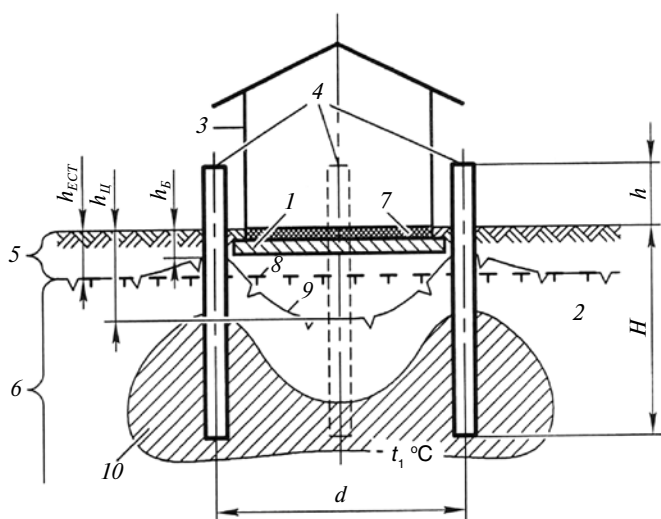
Схема на вечной мерзлоте здания с автономной системой охлаждения грунтов (дизайн первого типа): 1 – фундамент; 2 – грунты основания; 3 – корпус здания; 4 – охлаждающая система; 5 – талая зона грунта; 6 – мерзлая зона грунта; 7 – теплоизоляция; 8, 9 – нижняя граница талой зоны соответственно до и после постройки; 10 – твердомерзлое ядро в грунте
